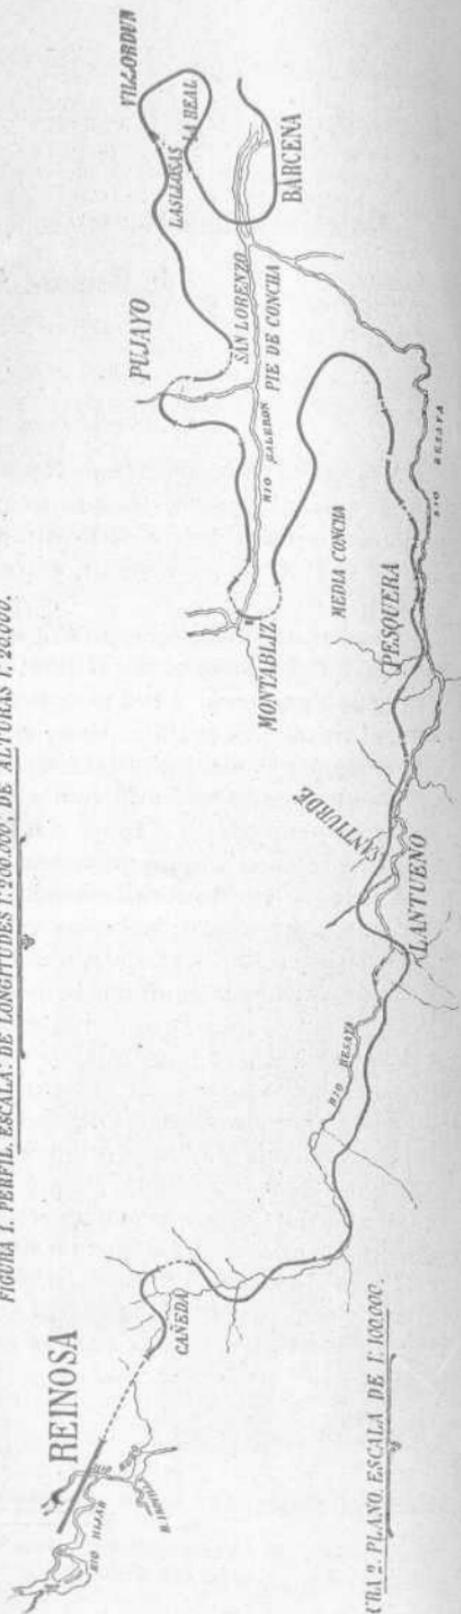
PLANO. ESCALA DE 1:100.000.
